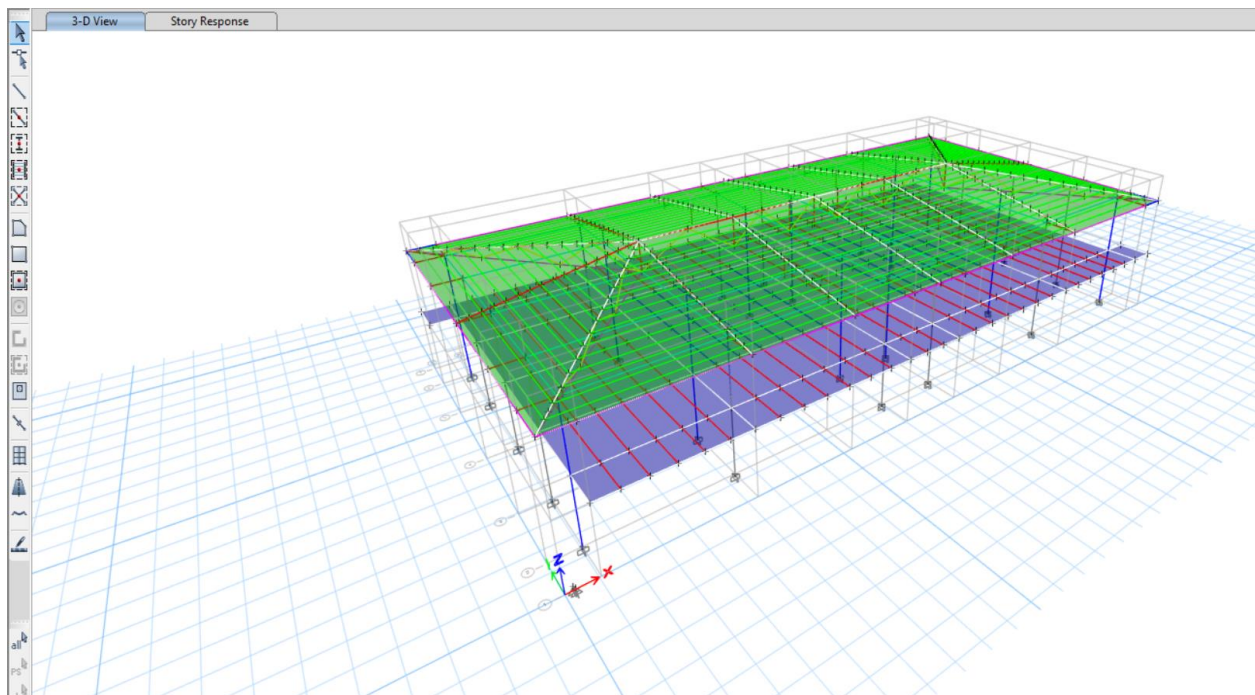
Vista en 3D del sistema estructural pórticos de acero .
